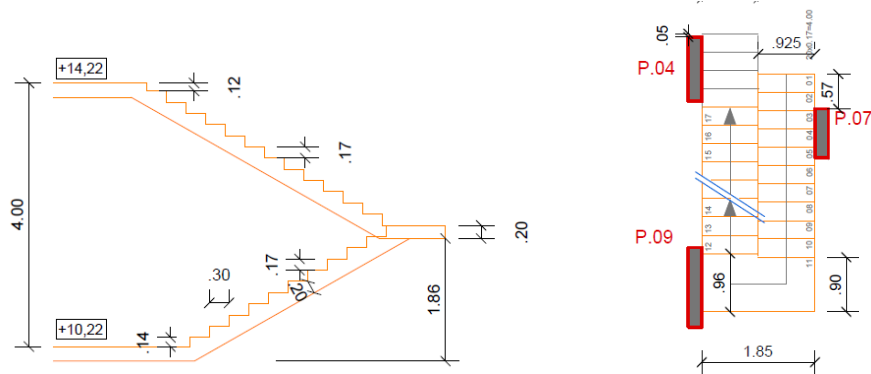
Planta e corte da escada do lote 6.7, piso -1.
